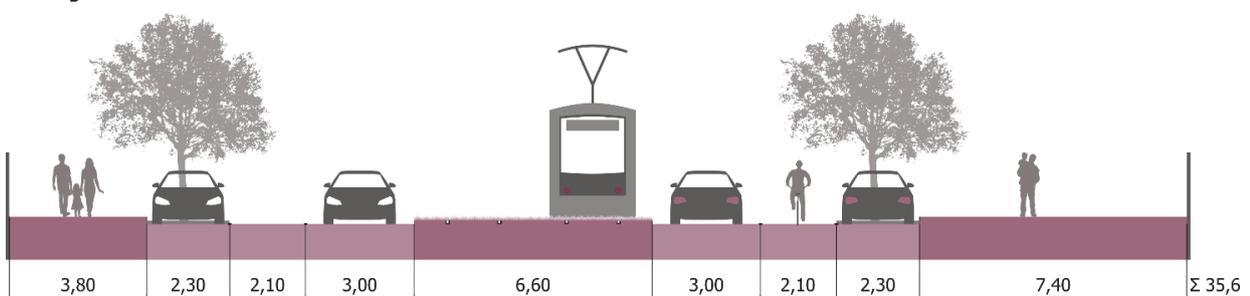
Regelquerschnitt 11, Vorgartenstraße Streckenbereich, Bestand und Planung
